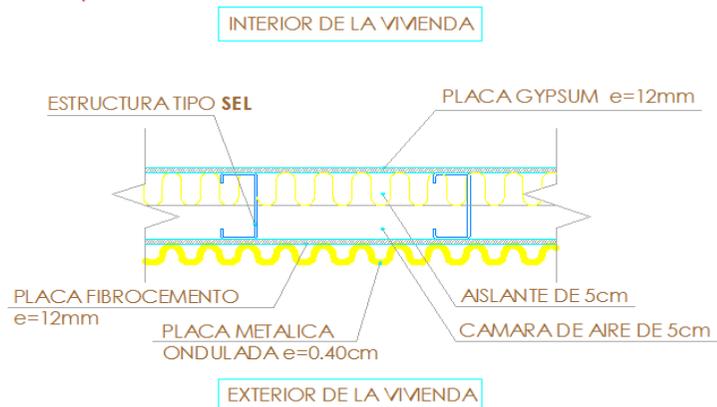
Estructura de tabiquería para Fachada Lateral.
